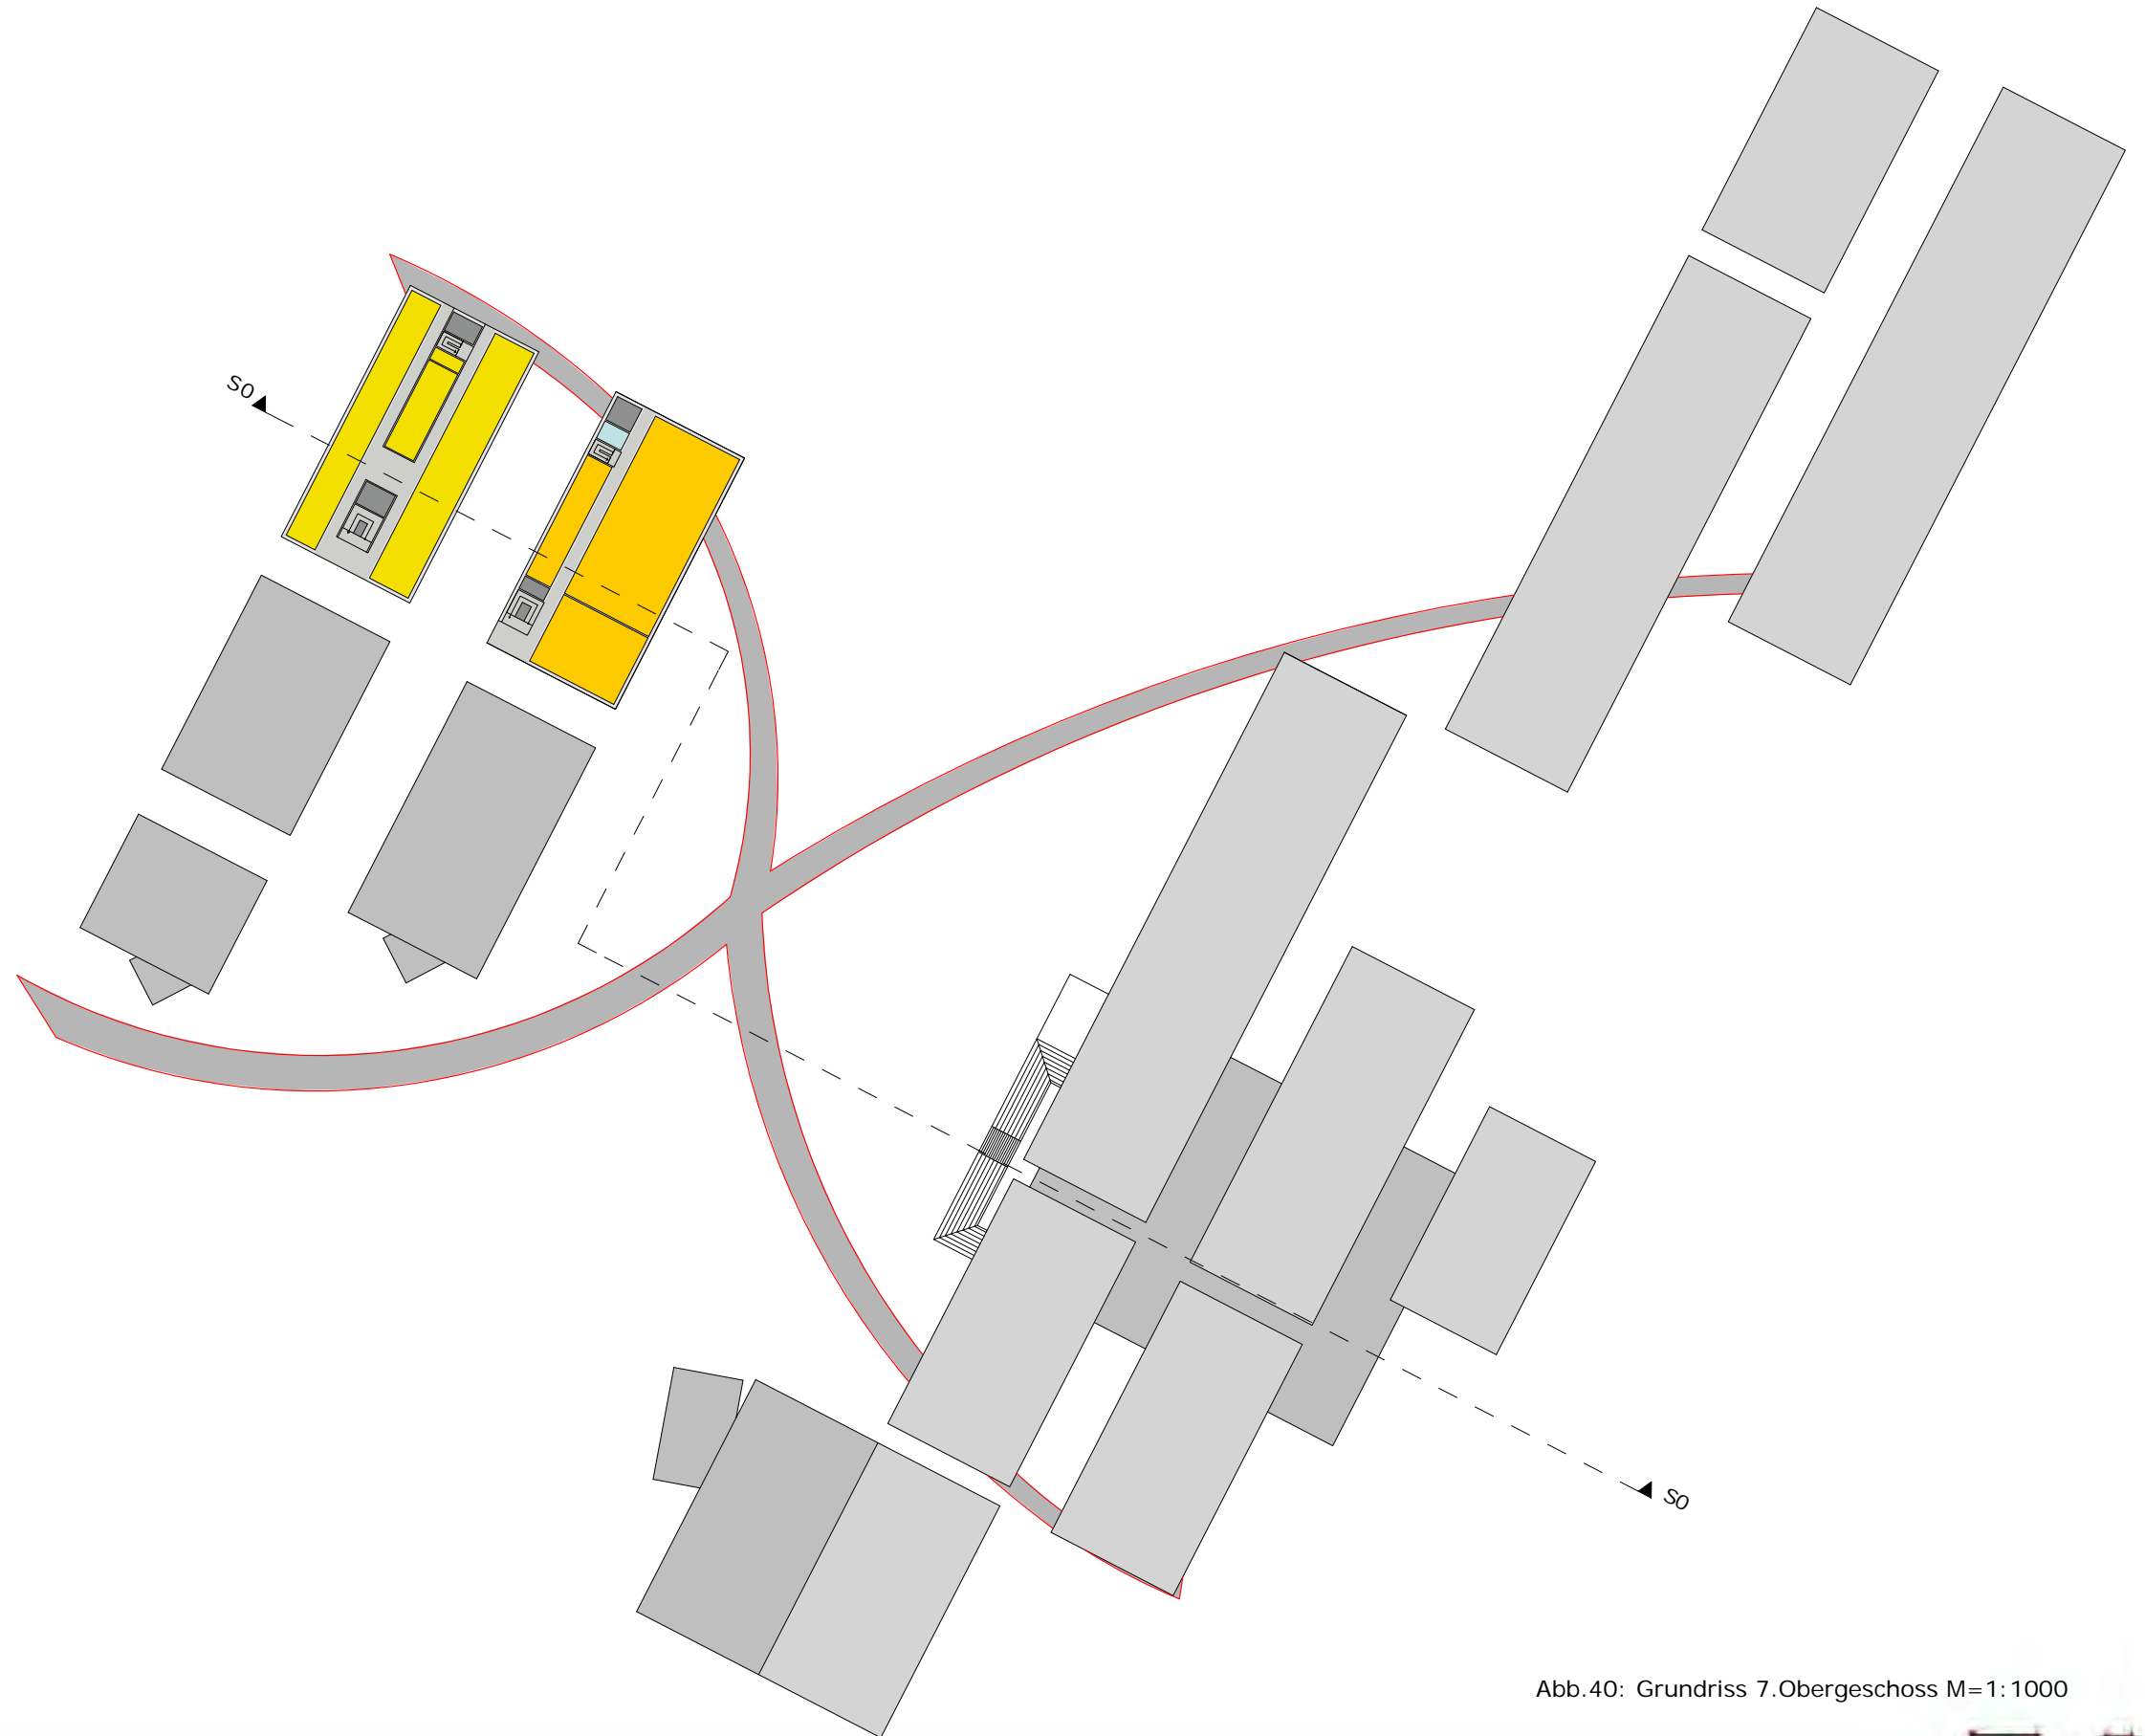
Grundriss 7.Obergeschoss M=1:1000
